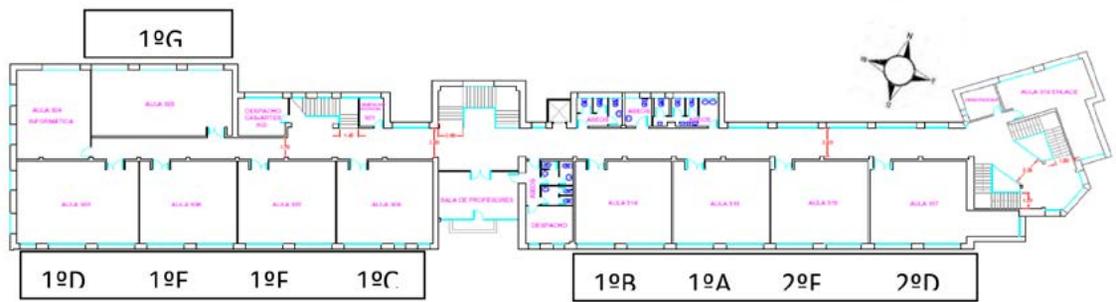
Edificio Secundaria/Bachillerato. Planta 4.
